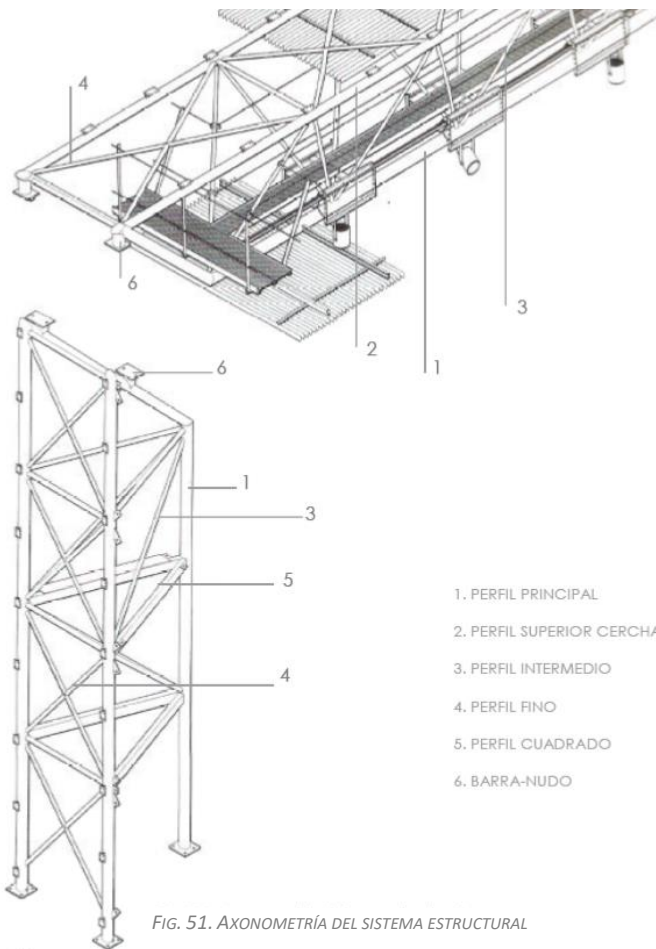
AXONOMETRÍA DEL SISTEMA ESTRUCTURAL
